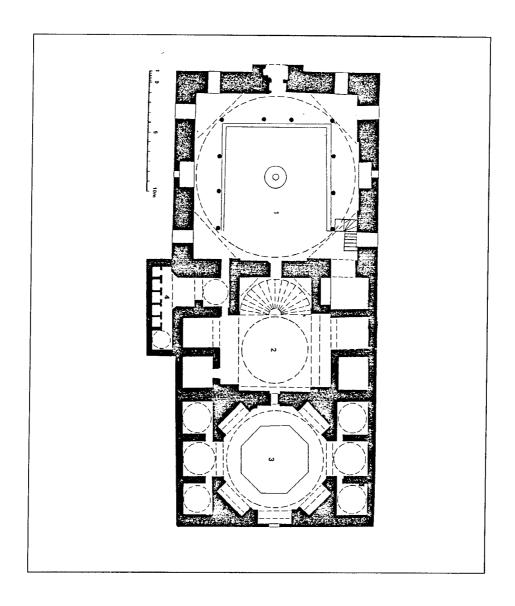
مسقط أفقي لعمارت نيلوفر خاتون بازنيق (عن : إيفردى) .
